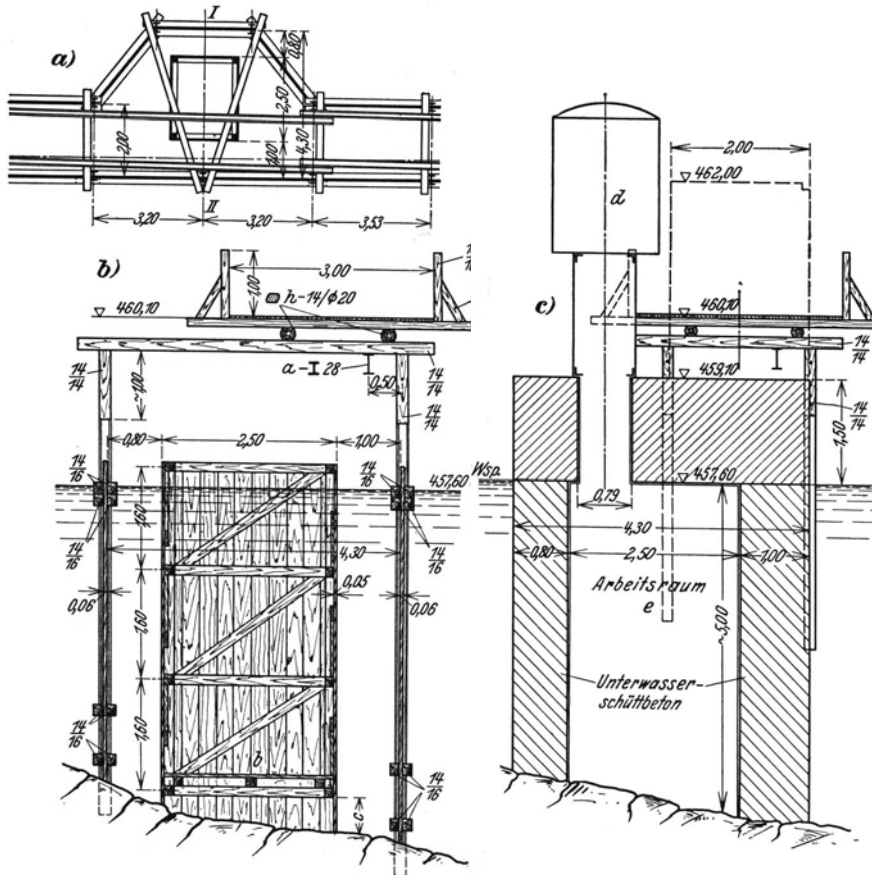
Betonierung des Grundwerkes eines Tauchwandpfeilers beim Murkraftwerk in Pernegg.
